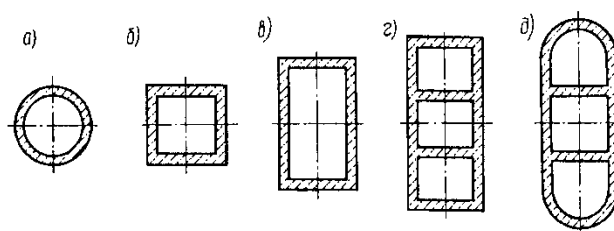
Формы сечений опускных колодцев в плане: а — круглая; б — квадратная; в — прямоугольная; г — прямоугольная с поперечными перегородками; д — с закругленными торцевыми стенками
